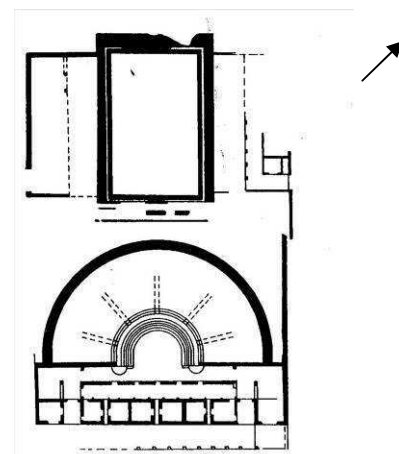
Plan du théâtre de Pietrabbondante, d'après Di Marco.
